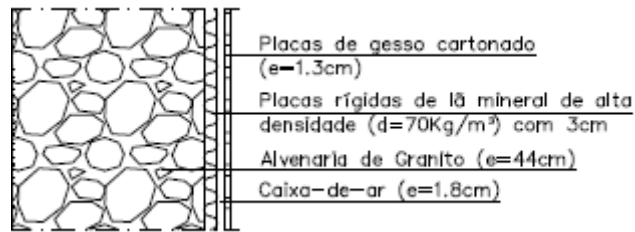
Corte da Parede PE1 (Fonte: Porto Vivo, SRU)
